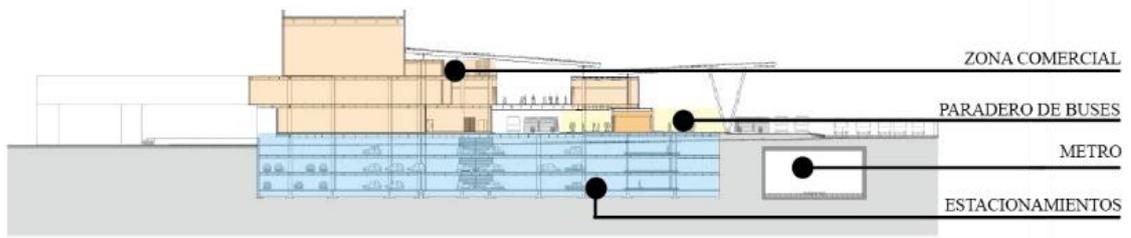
Corte transversal 1 Estación Cuatro Caminos. Fuente: Archdaily, 2018
